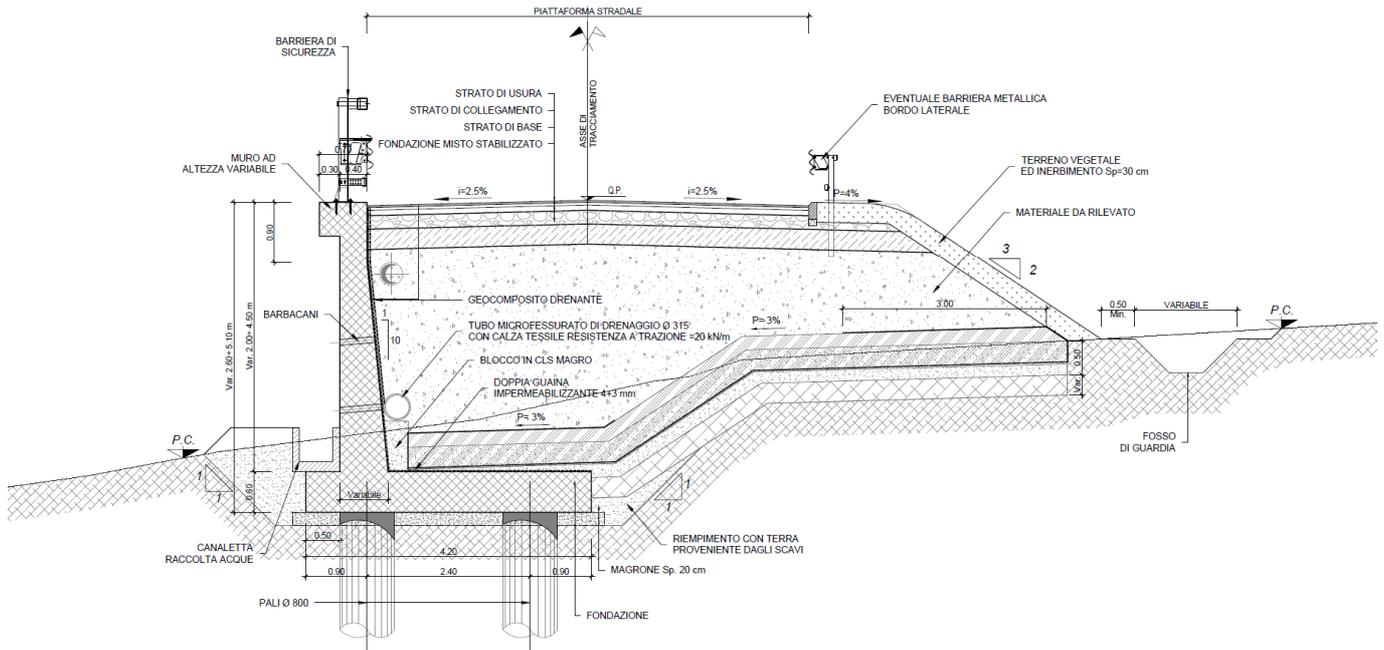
Sezione tipo in rilevato con muri di sostegno (tipo ST-1)
